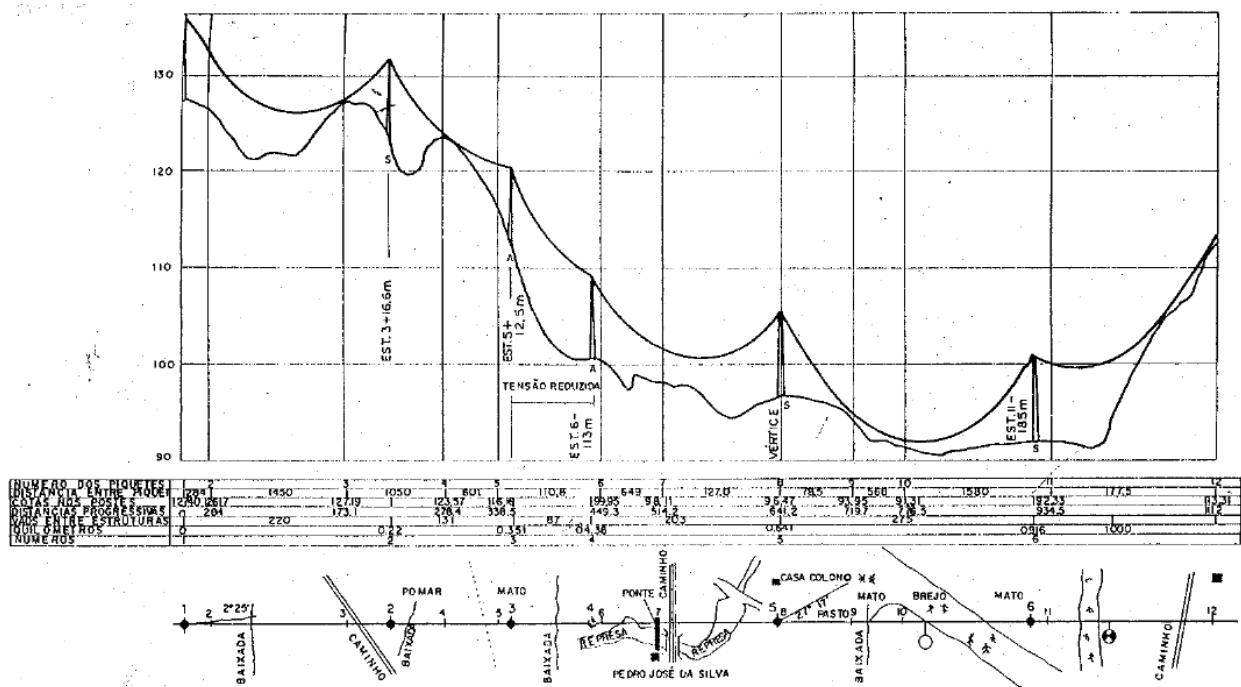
Exemplo de projeto de distribuição de estruturas (Plotação) Perfil e Planta da LT. Retirado de [44]
